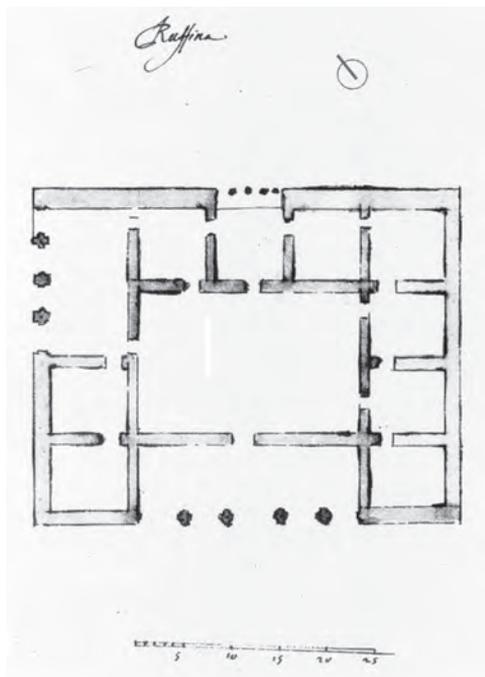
La Rufina nella pianta delle Stroziane (simbolo del nord aggiunto).
